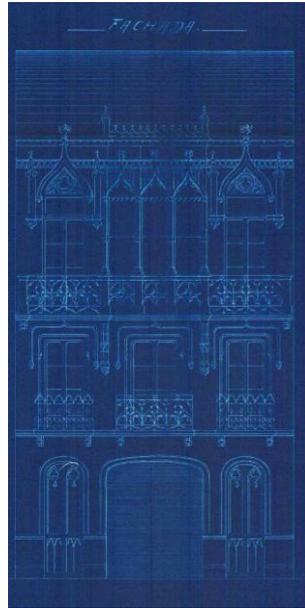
Fachada principal del proyecto de edificio para la Vizcondesa de Villandrando (actual Calle Bajada de la Libertad, 23). Teodosio Torres. 6 de marzo de 1907. Fuente: AMVa, caja 609-20
